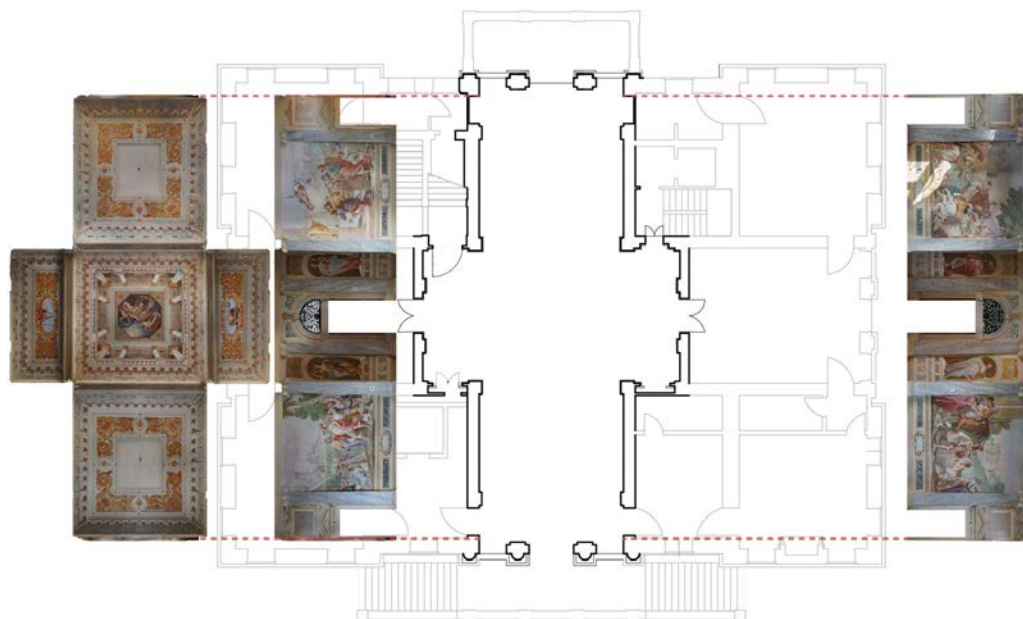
Pianta del primo piano con ortofoto delle pareti e soffitto della sala affrescata.
